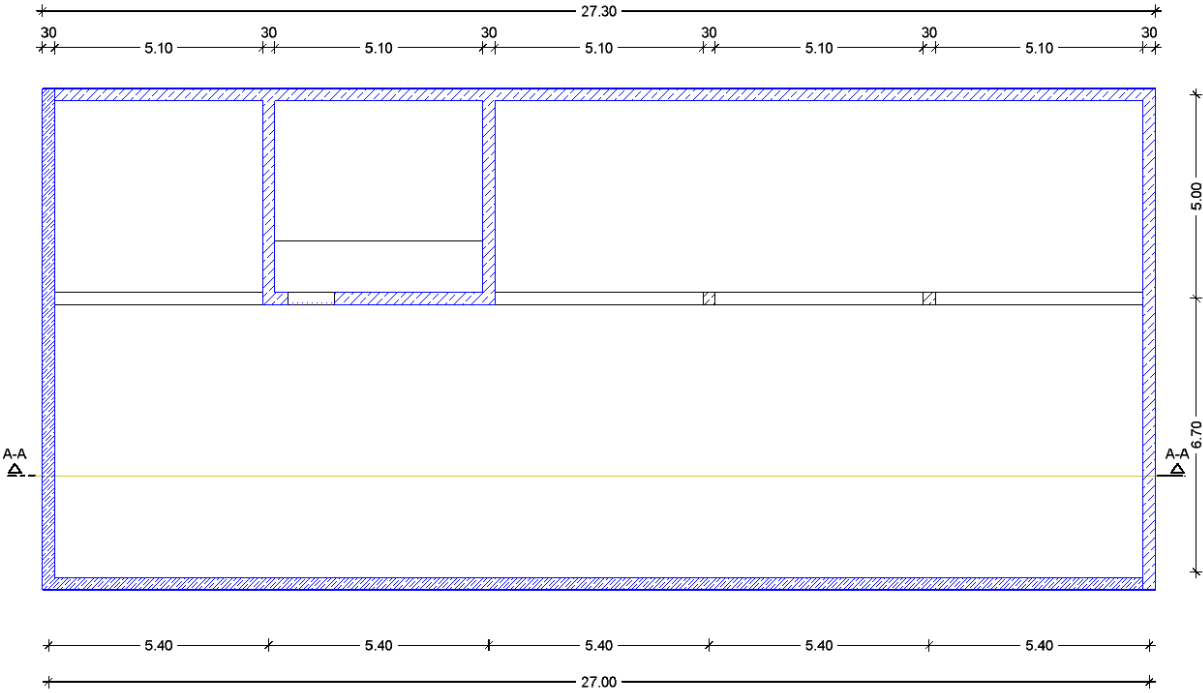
Grundriss: Kellergeschoss [44]
